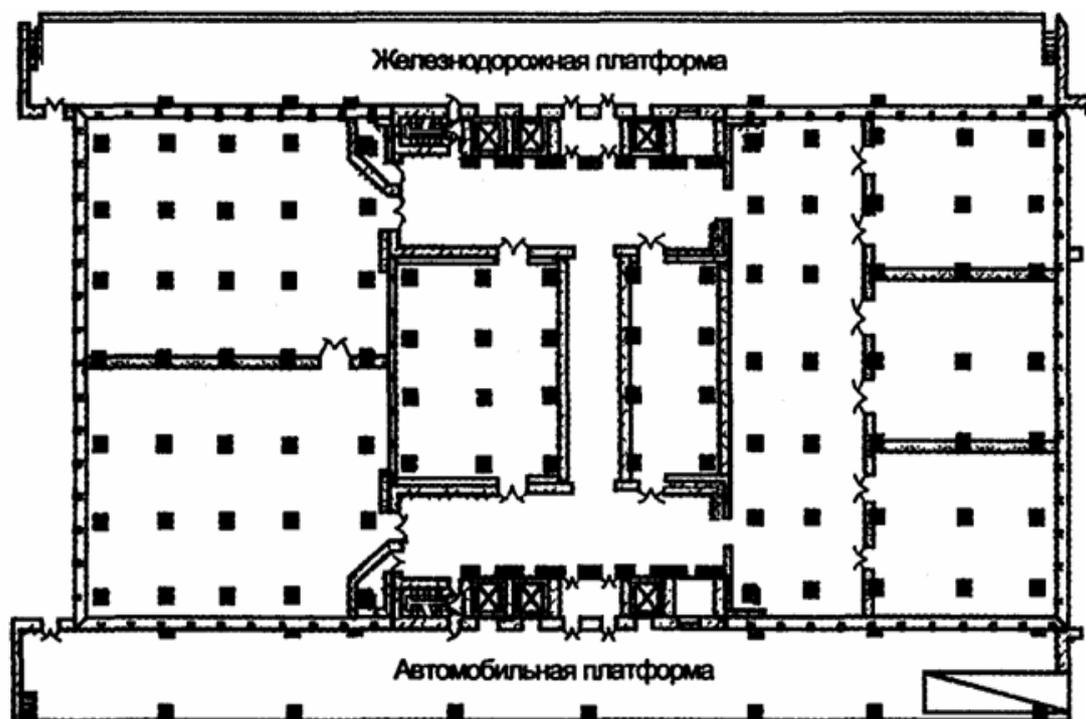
Размещение лестничных клеток у наружных стен здания холодильника
